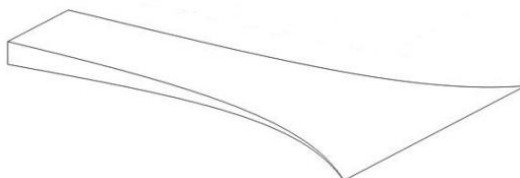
Констэра – балка с постоянной площадью поперечного сечения.
